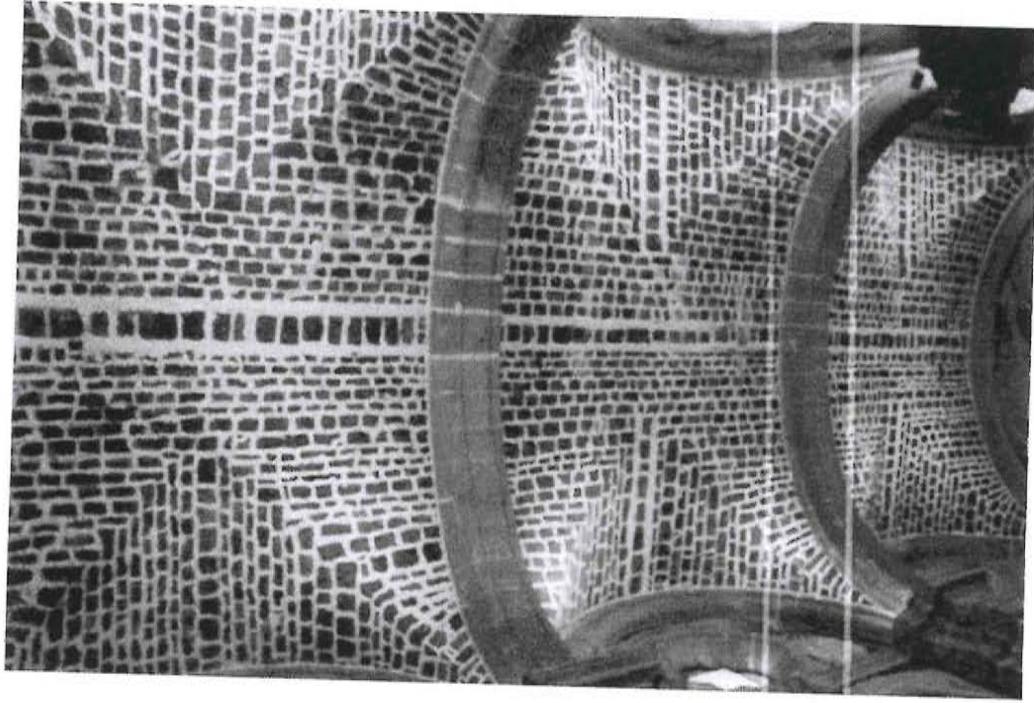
Edificio de acervo, fisura por el interior de la fachada norte.
